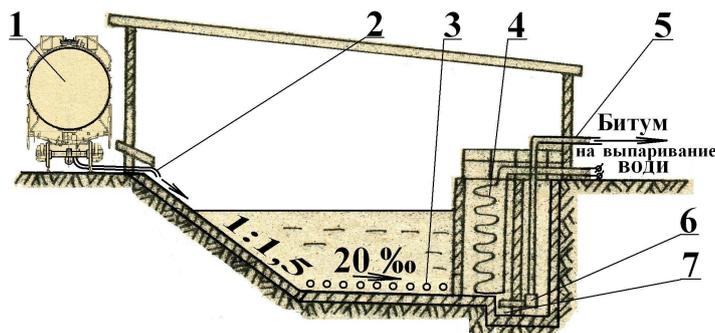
Битумохранилище с донным трубопроводным подогревом и электрическим подогревом в прямке: 1 – железнодорожная цистерна с битумом; 2 – трубопровод для выкачки битума с железнодорожной цистерны; 3 – трубопровод газового, парового или жидкостного подогрева; 4 – электрический нагреватель битума в прямке; 5 – битумопровод; 6 – битумный насос; 7 – прямок.
